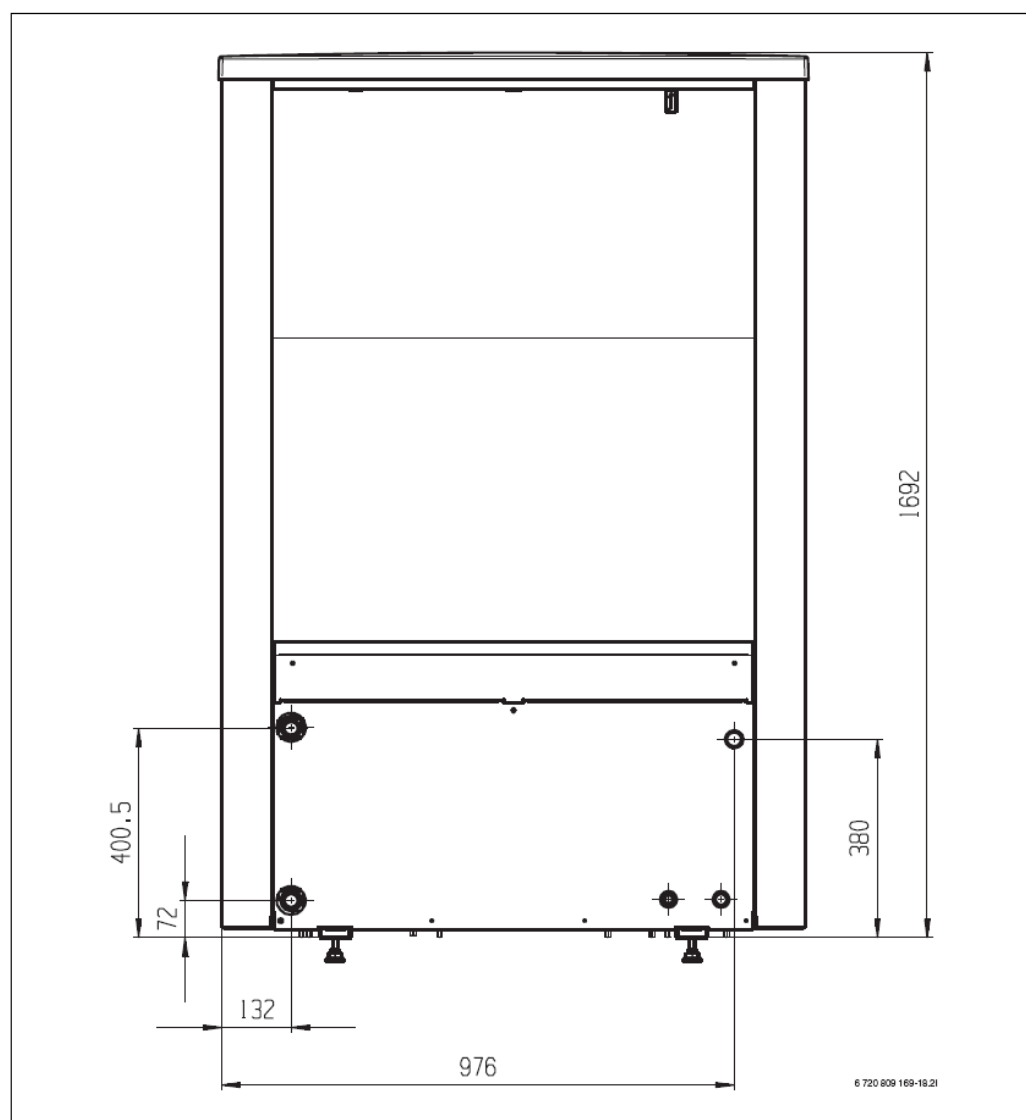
Габаритные размеры и места подключений наружного блока 13/17, тыльная сторона
